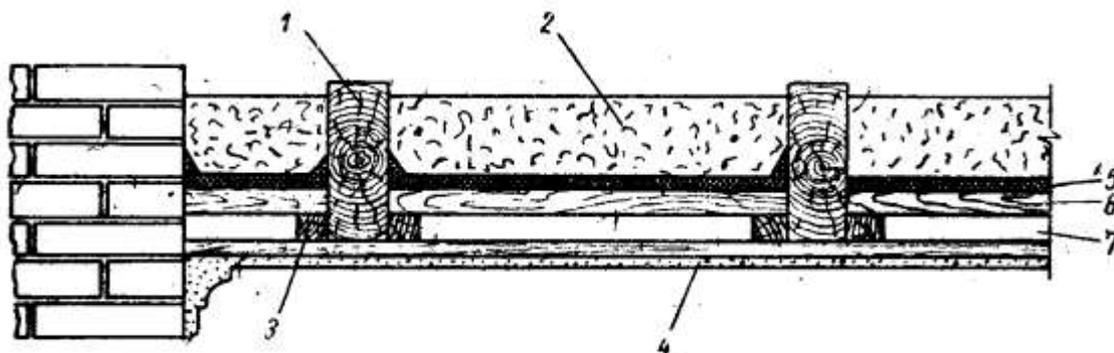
Чердачное перекрытие с разрезным накатом: 1 – балка; 2 – шлак; 3 – черепной брусок; 4 – штукатурка; 5 – смазка; 6 – накат; 7 – зазор
